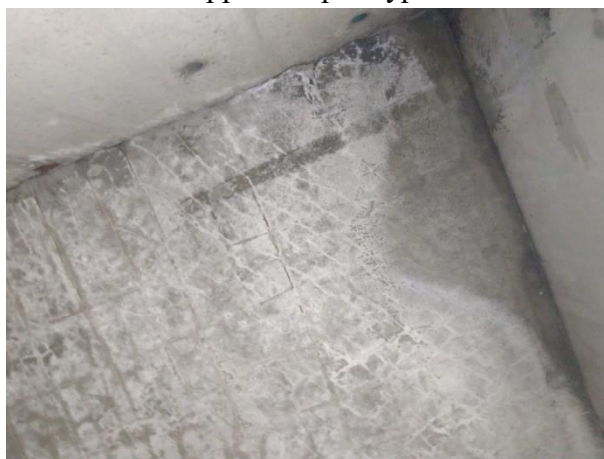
Частичное разрушение защитного слоя бетона, оголение и коррозия арматуры
